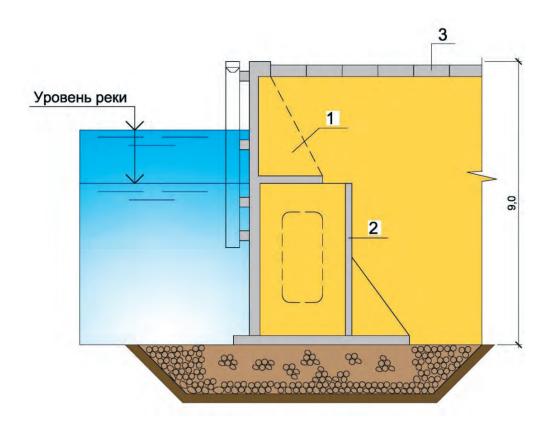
Конструкция причального сооружения из железобетонных массивов-гигантов: 1 — контрфорсная надстройка; 2 — массив-гигант; 3 — железобетонное покрытие
